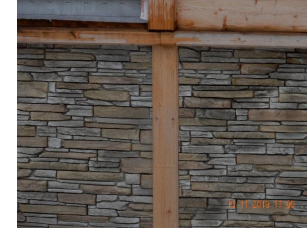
bis 7 – Massivbau – Außenwände mit Porenbetonsteinen.
